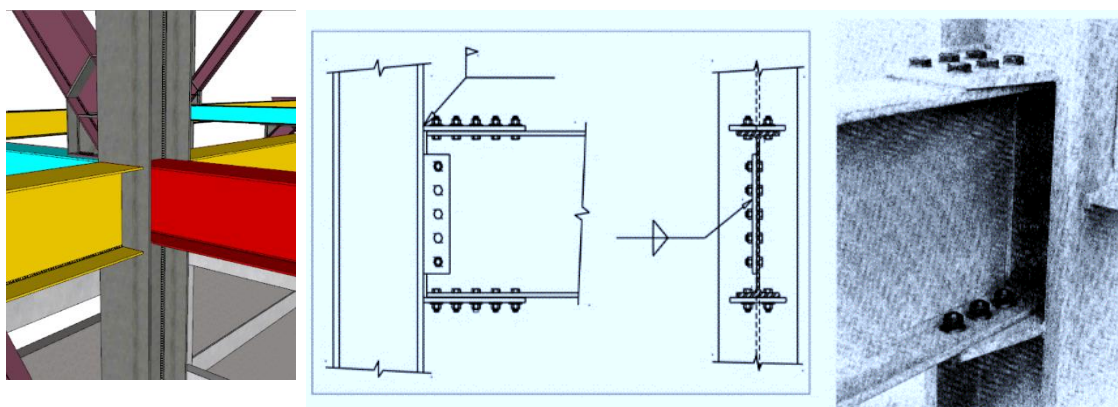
Viga amarilla: 0.45 m. de peralte. Conexión Viga-Columna: Placas horizontales en patines de la viga. Fuente: Elaboración propia
